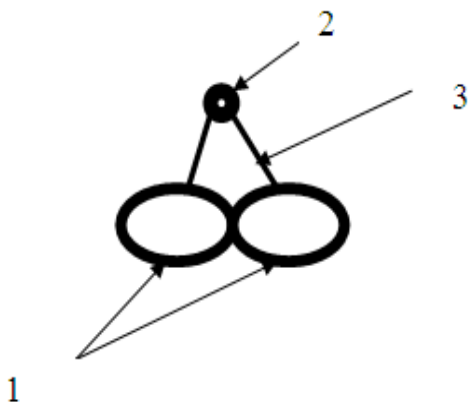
Поперечный разрез мостотоннеля в замковом створе (в середине пролета): 1 – труба – балка жесткости; 2– кабель; 3– подвески.
